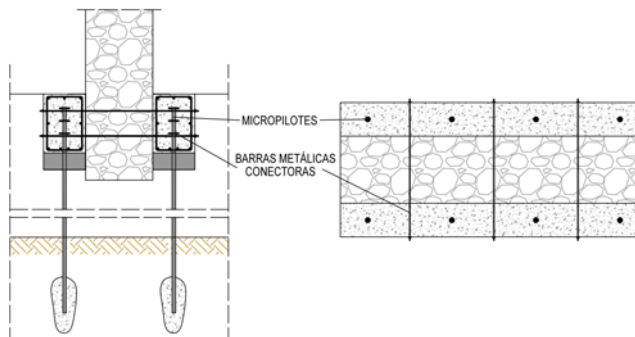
Refuerzo 4 mediante micropilotes de zapata corrida bajo muro. Fuente propia.
